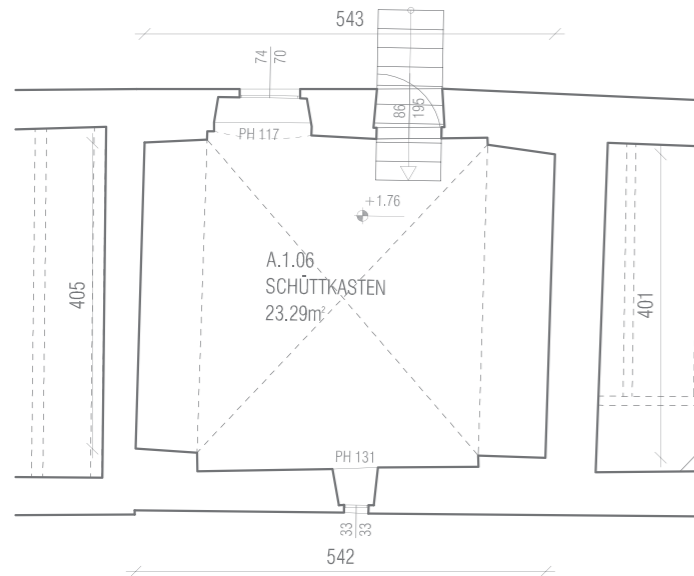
Grundriss Raum A.1.06_1:100
